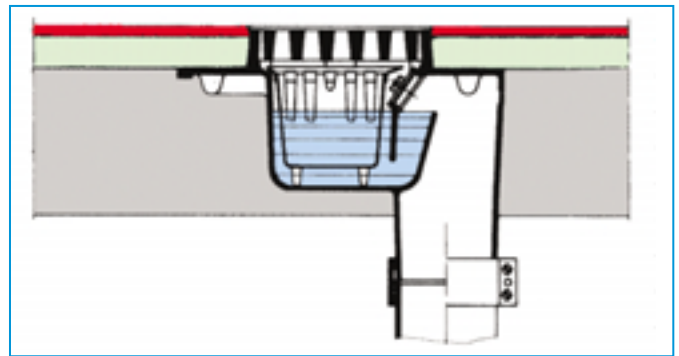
Bodenablauf mit Klebe-/Pressdichtungsflansch, Typ 3 in Bodenaufbau mit Abdichtung durch Dichtungsbahn
